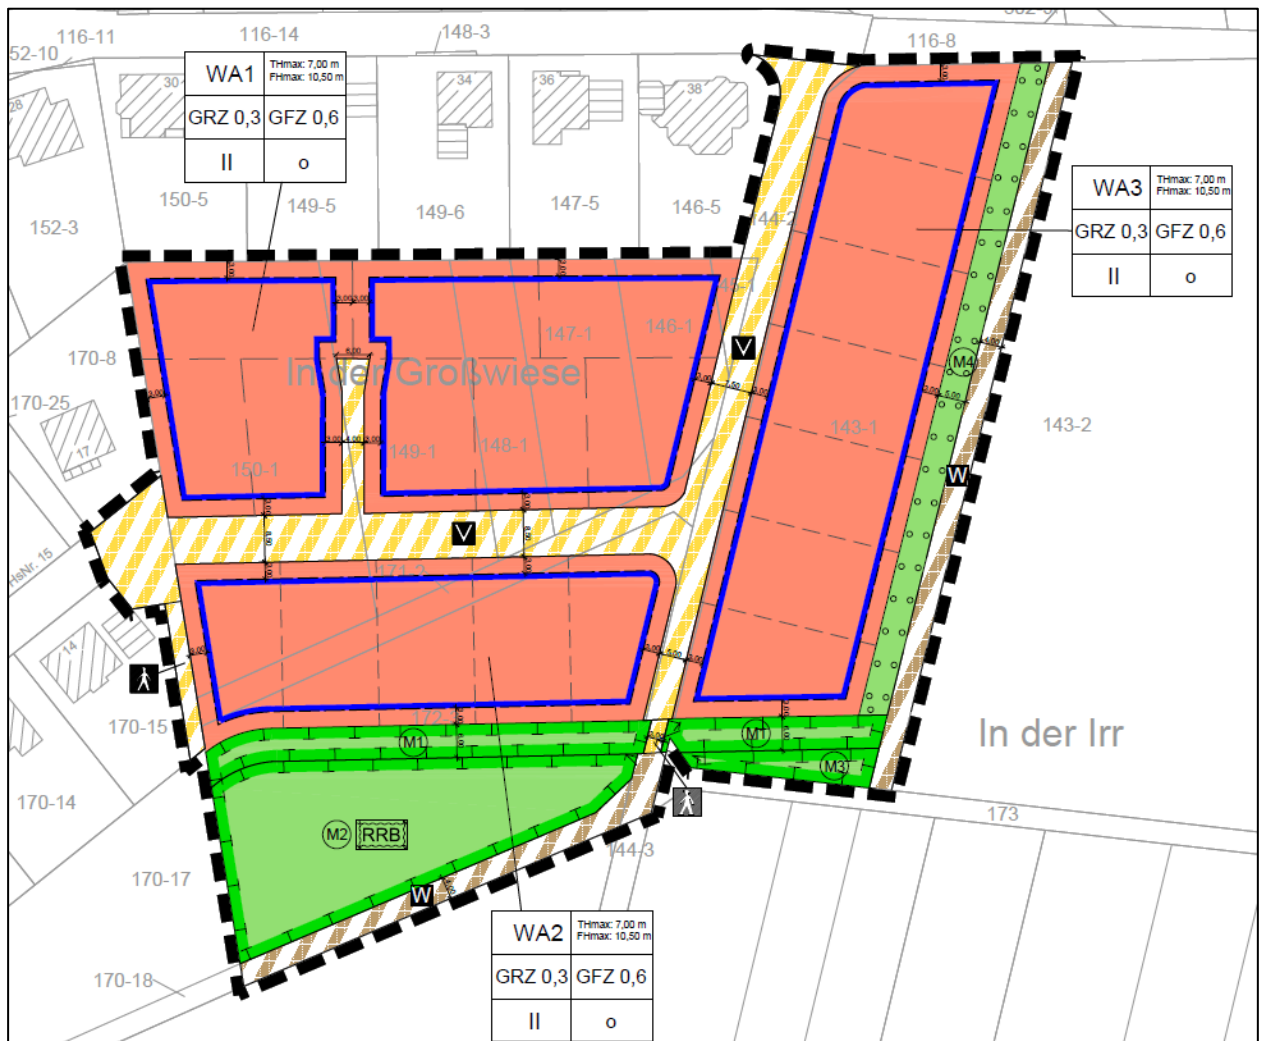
Planzeichnung des Bebauungsplans „In den Bohngärten – 2. Bauabschnitt, Änderung II“; Quelle: VG Göllheim
